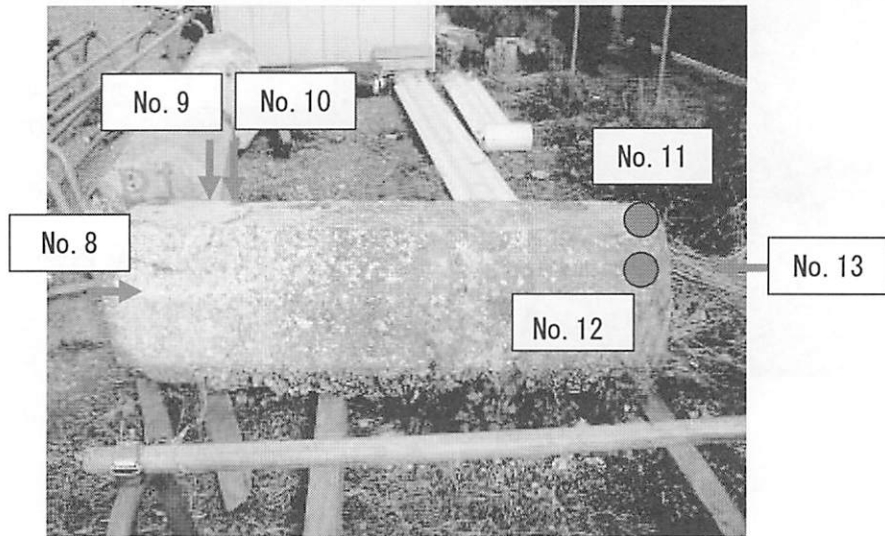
透気試験測定位置2(橋脚部)
